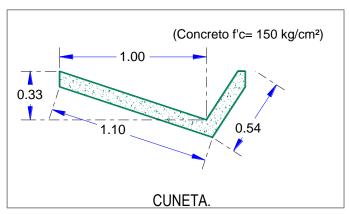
Geometría de contracuneta, Detalle, 2017
